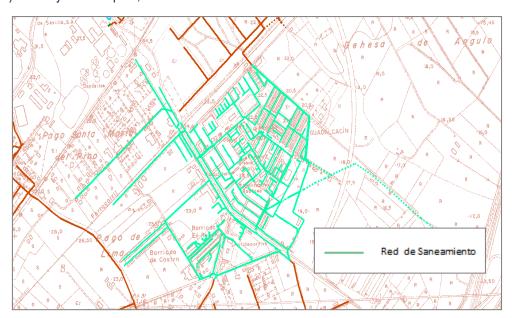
Esquema de la red de alcantarillado de Guadalcacín.
